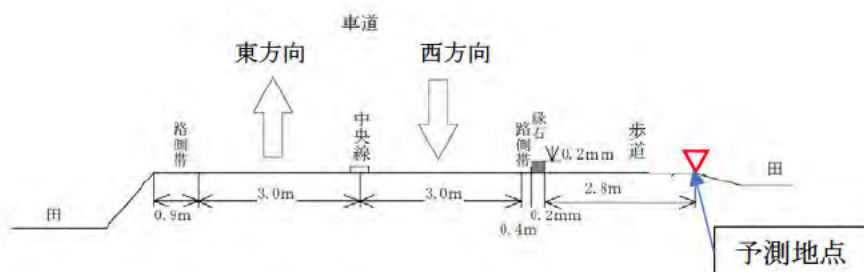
騒音予測地点d近傍の道路断面図
